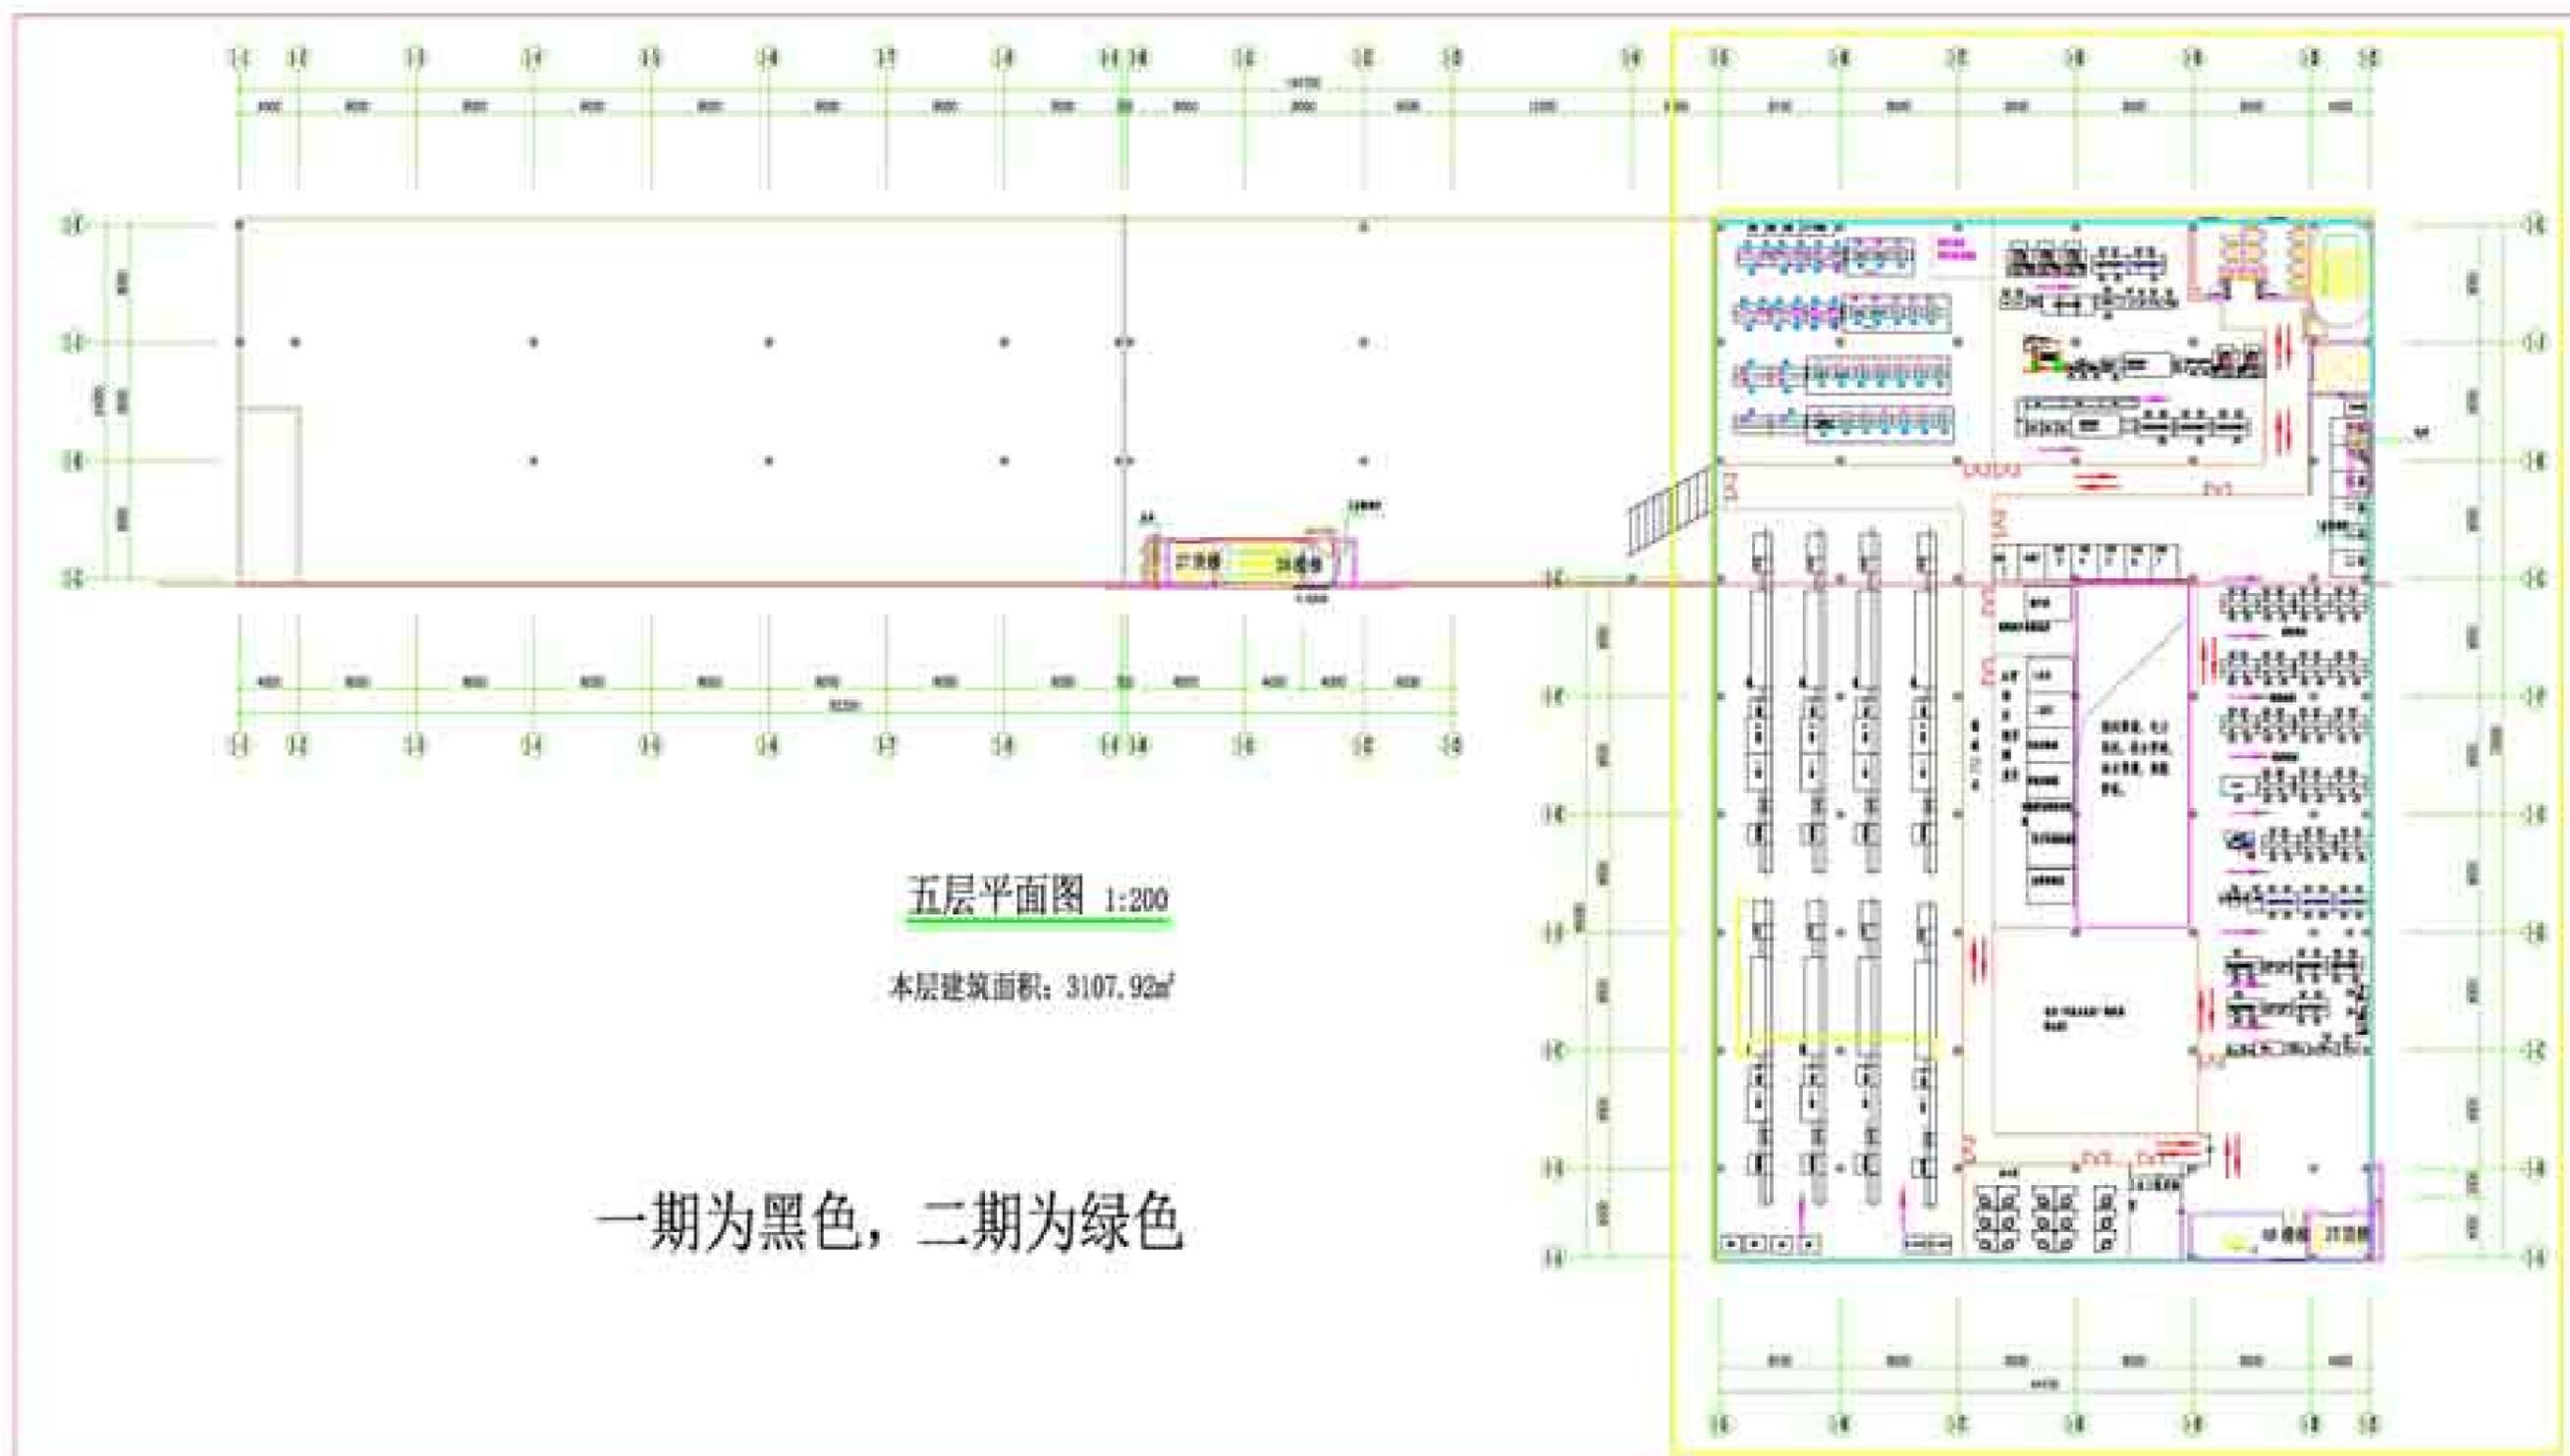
(e) 本项目 1# 厂房平面布置图 (五层)
